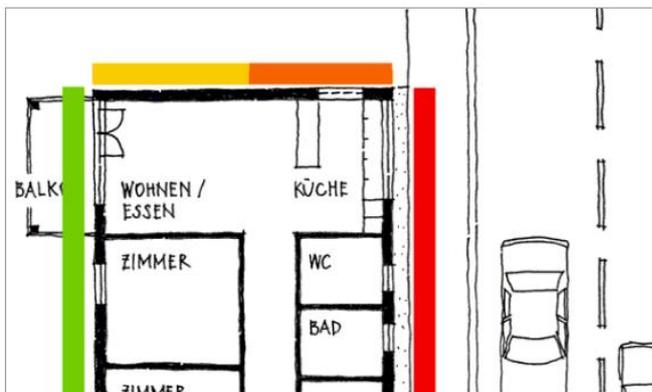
Beispiel eines «lärmoptimierten Grundrisses» (Quelle: <https://www.bauen-im-laerm.ch/grundriss-ausrichtung/laermoptimierte-grundrisse/>)
